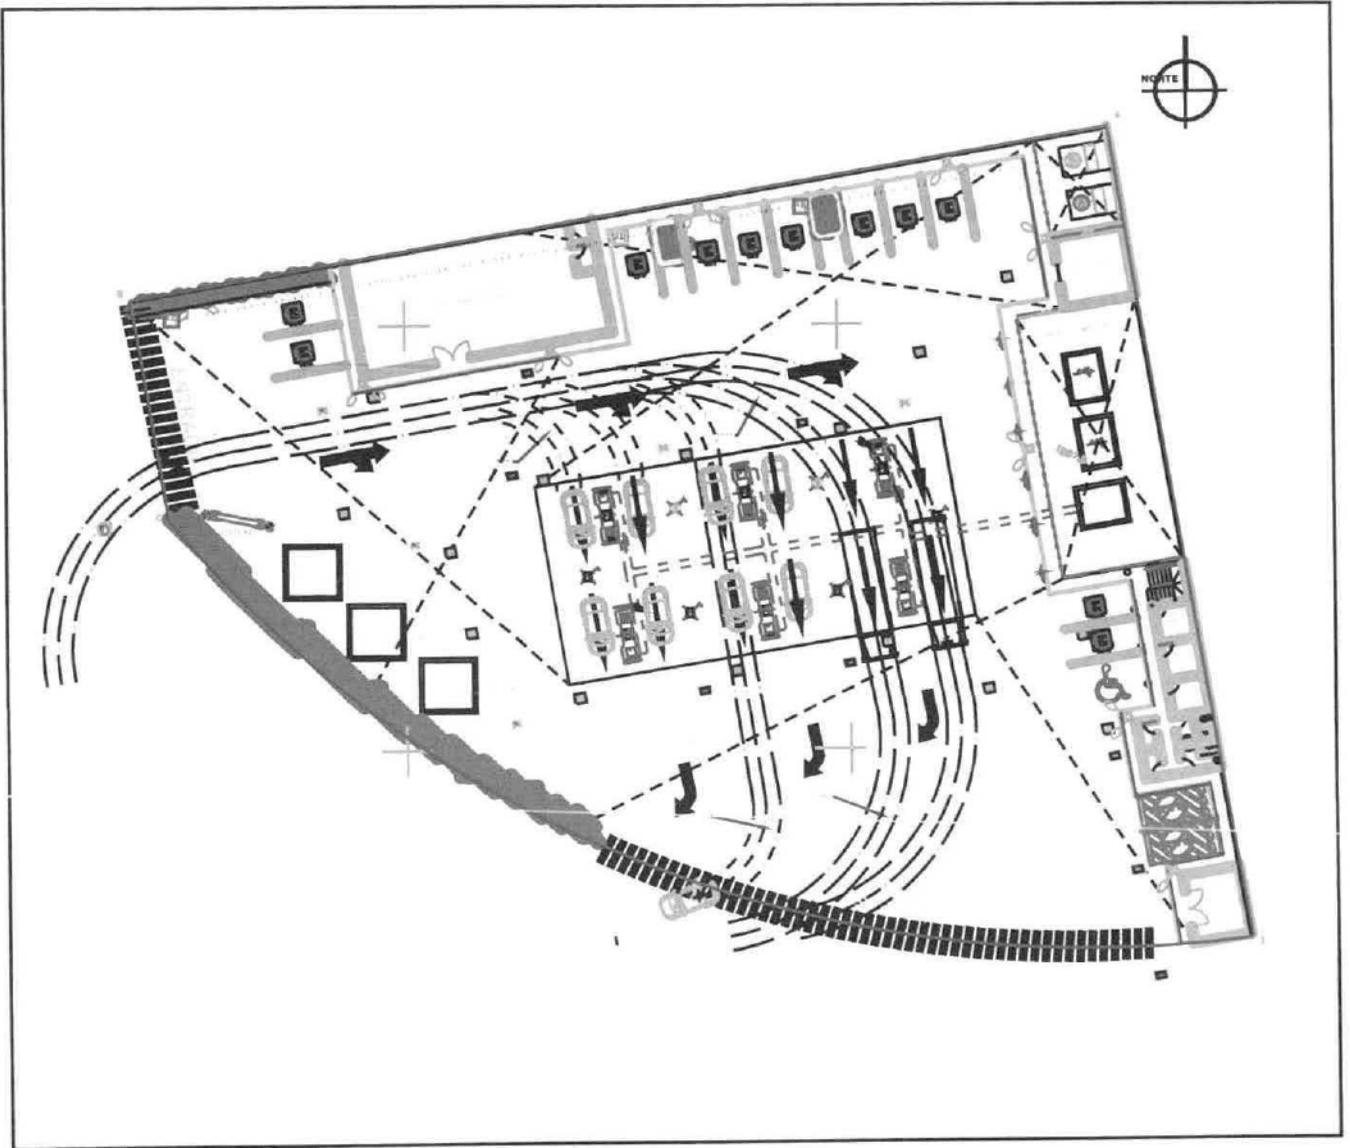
Planta de Conjunto (Proyecto Arquitectónico)
